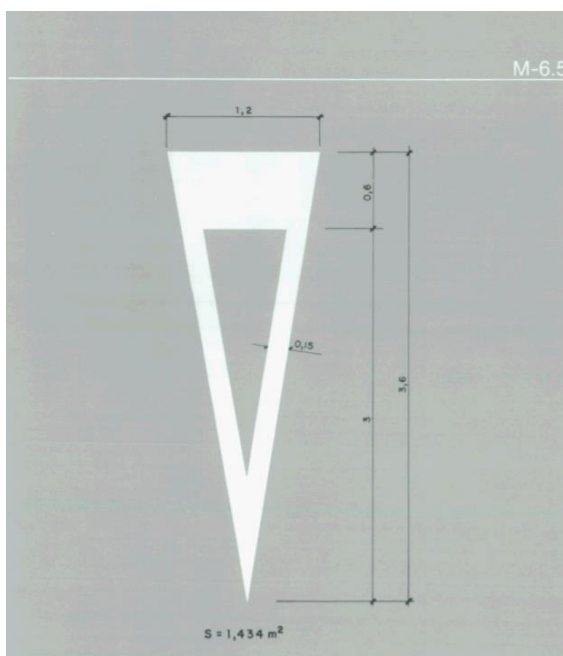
Marca transversal M-6.5 (Fuente: Norma 8.2-IC)
